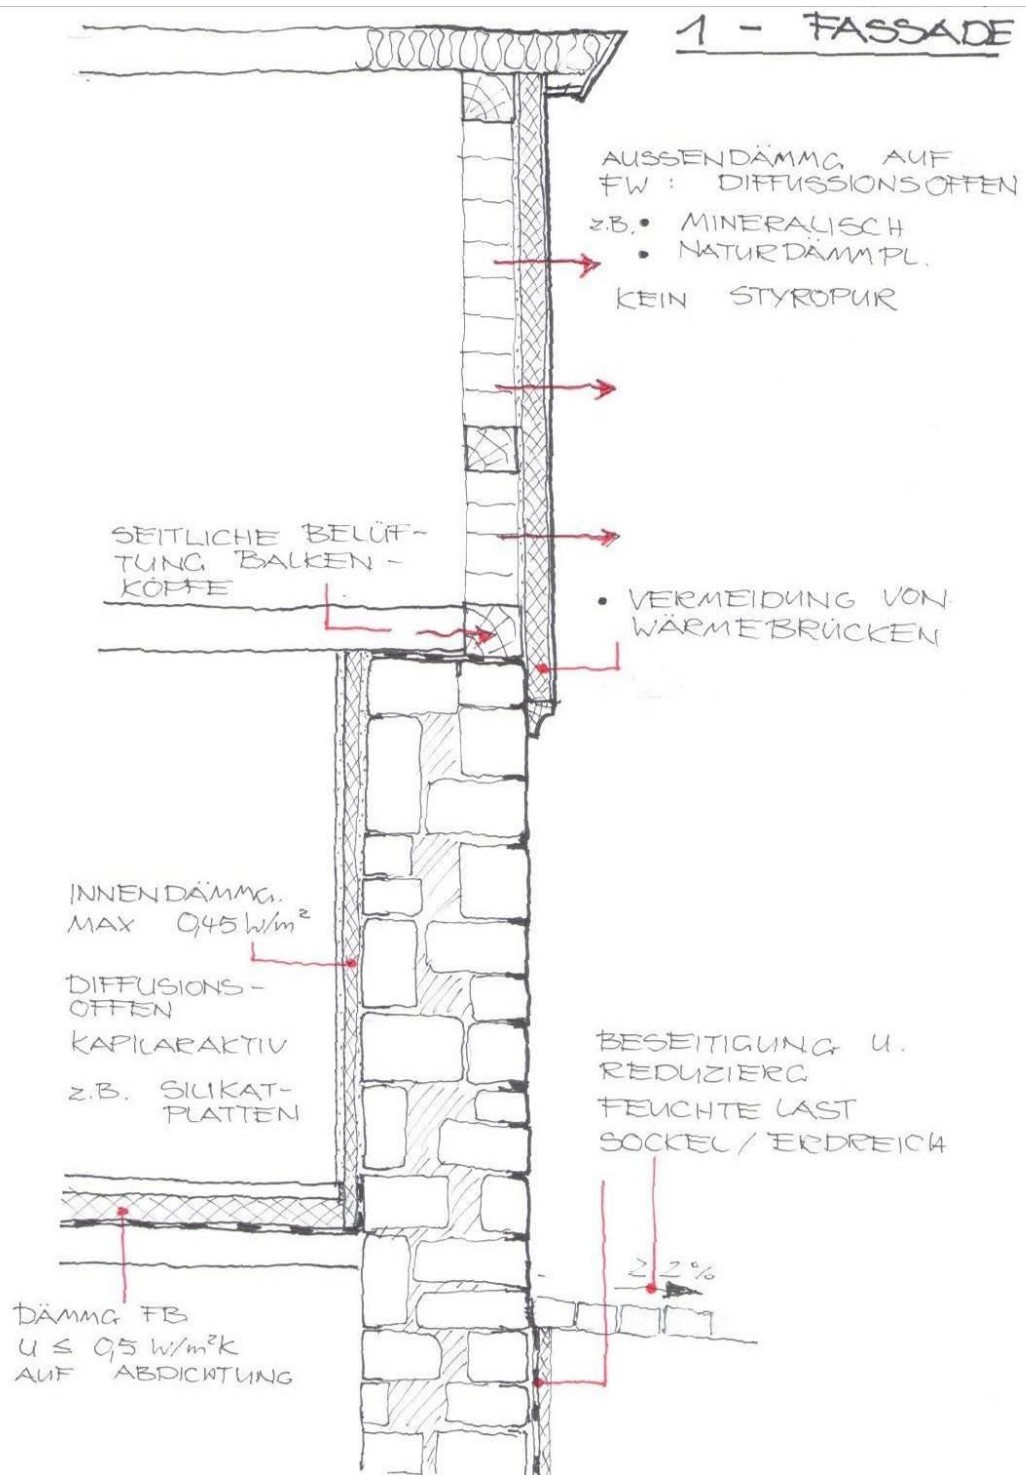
Schema: Außendämmung Fachwerkfassade (Quelle: Holz)
